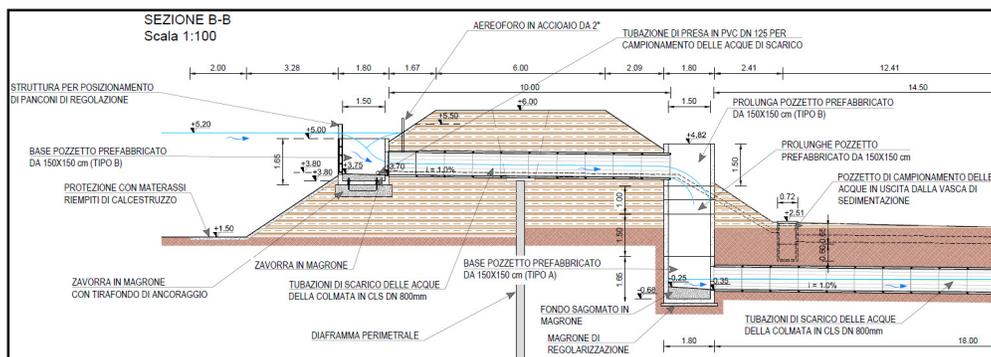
Sezione del manufatto di scarico a mare – attraversamento argine
